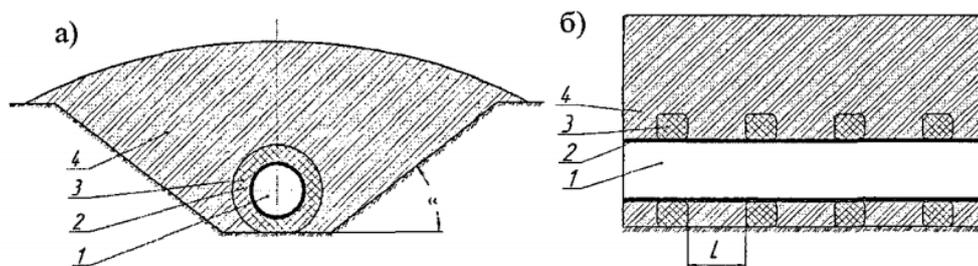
Прокладка трубопровода в траншею с упругопластичными элементами [8]
